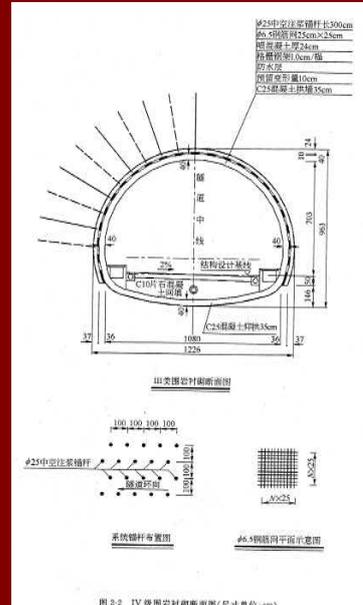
IV 级围岩衬砌断面图(尺寸单位:cm)
